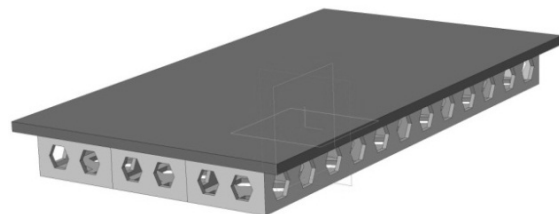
Конструкция сталежелезобетонного пролетного строения
